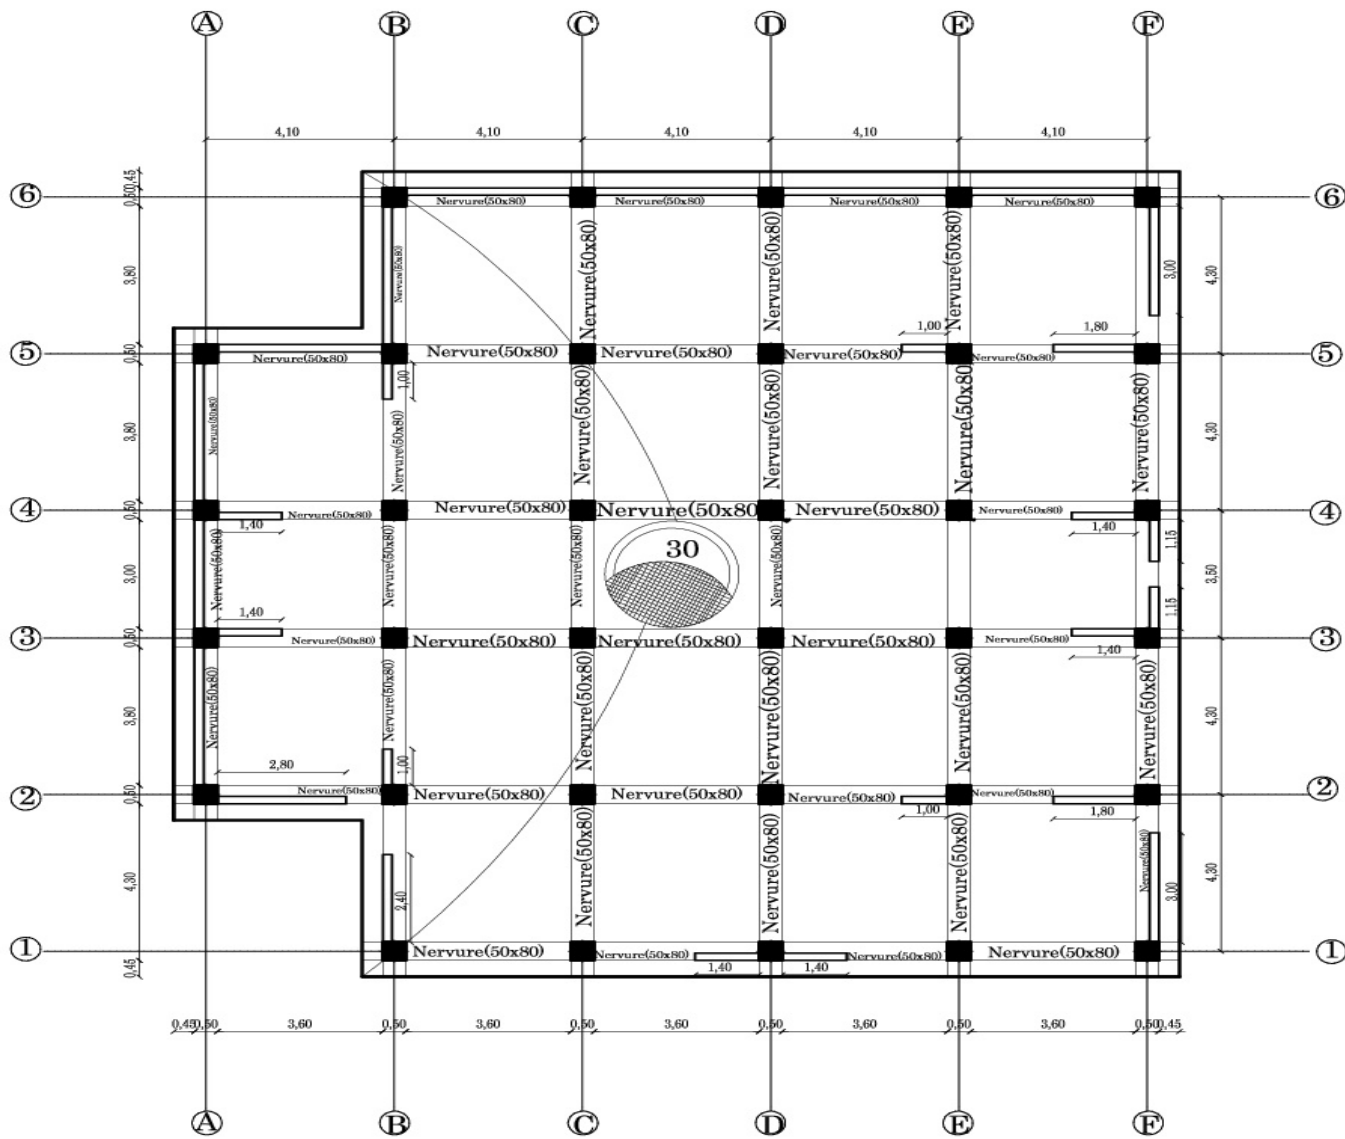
Plan de ferrailage des nervures suivant Y.
